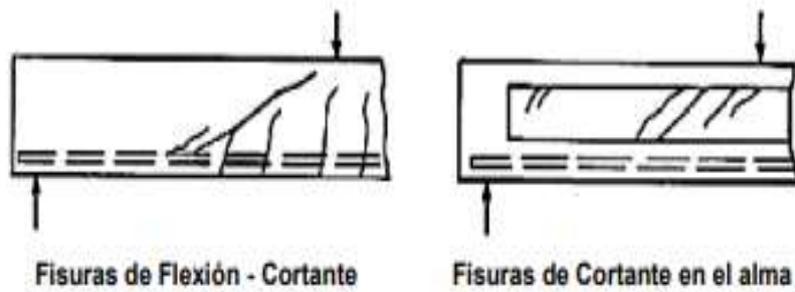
Grietas de flexión-cortante y de cortante en el alma, en el concreto. [52]
